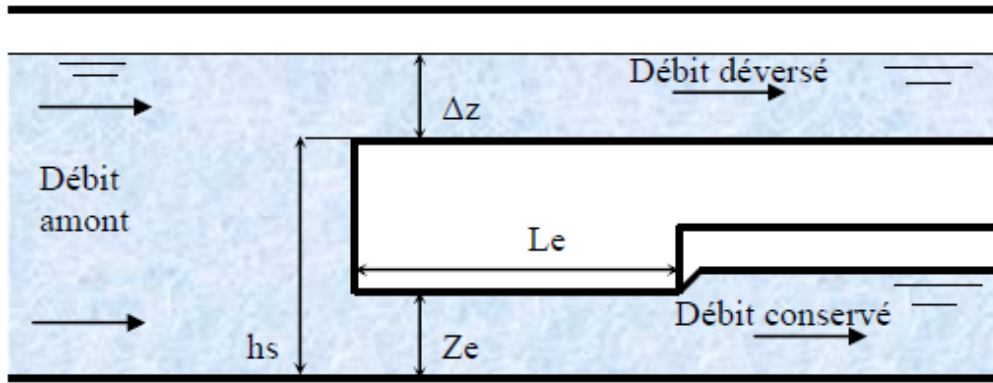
Vue en coupe du déversoir frontal à seuil haut
